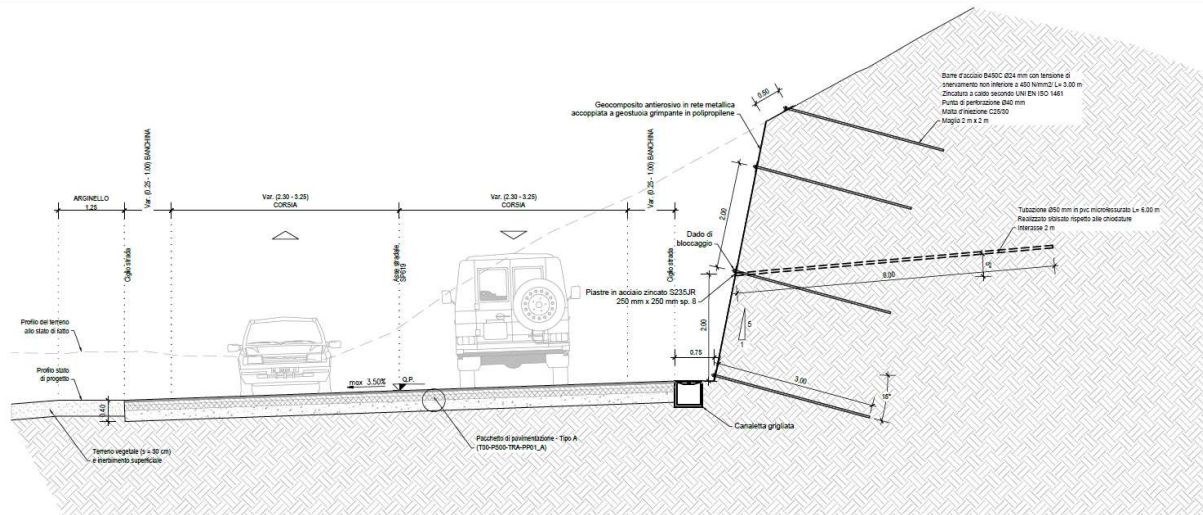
Sezione tipo SP619 con rafforzamento corticale in corrispondenza della curva d'innesto
